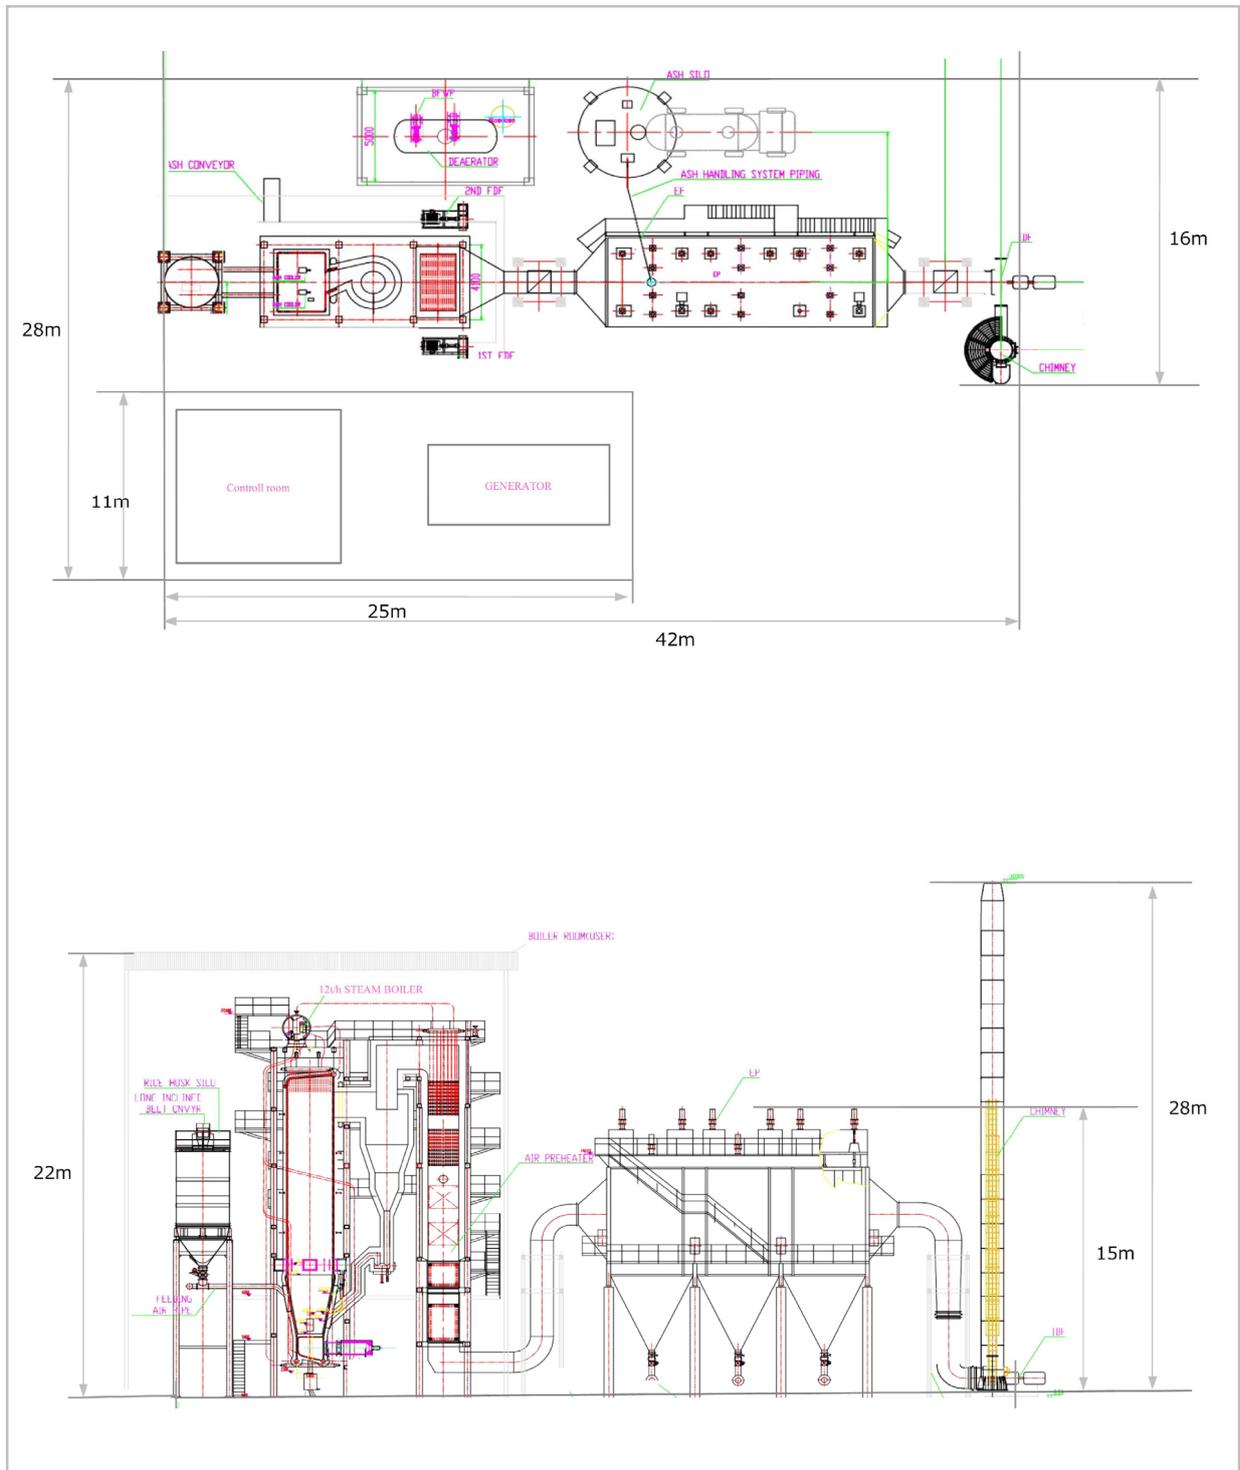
施設平面図・立面図(直接燃烧方式 1,000kW)
